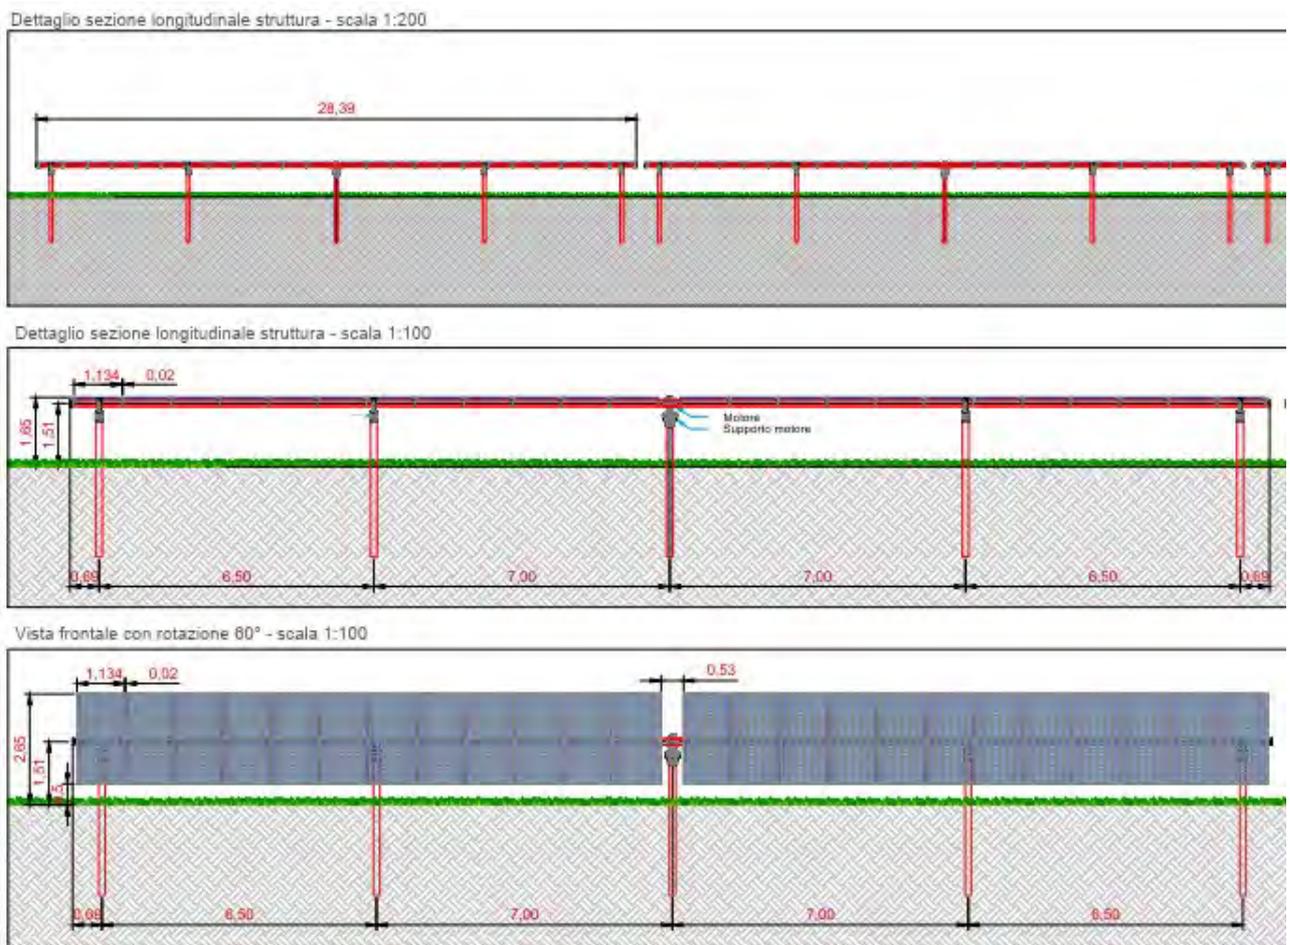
Sezione longitudinale tipologica struttura Tracker
